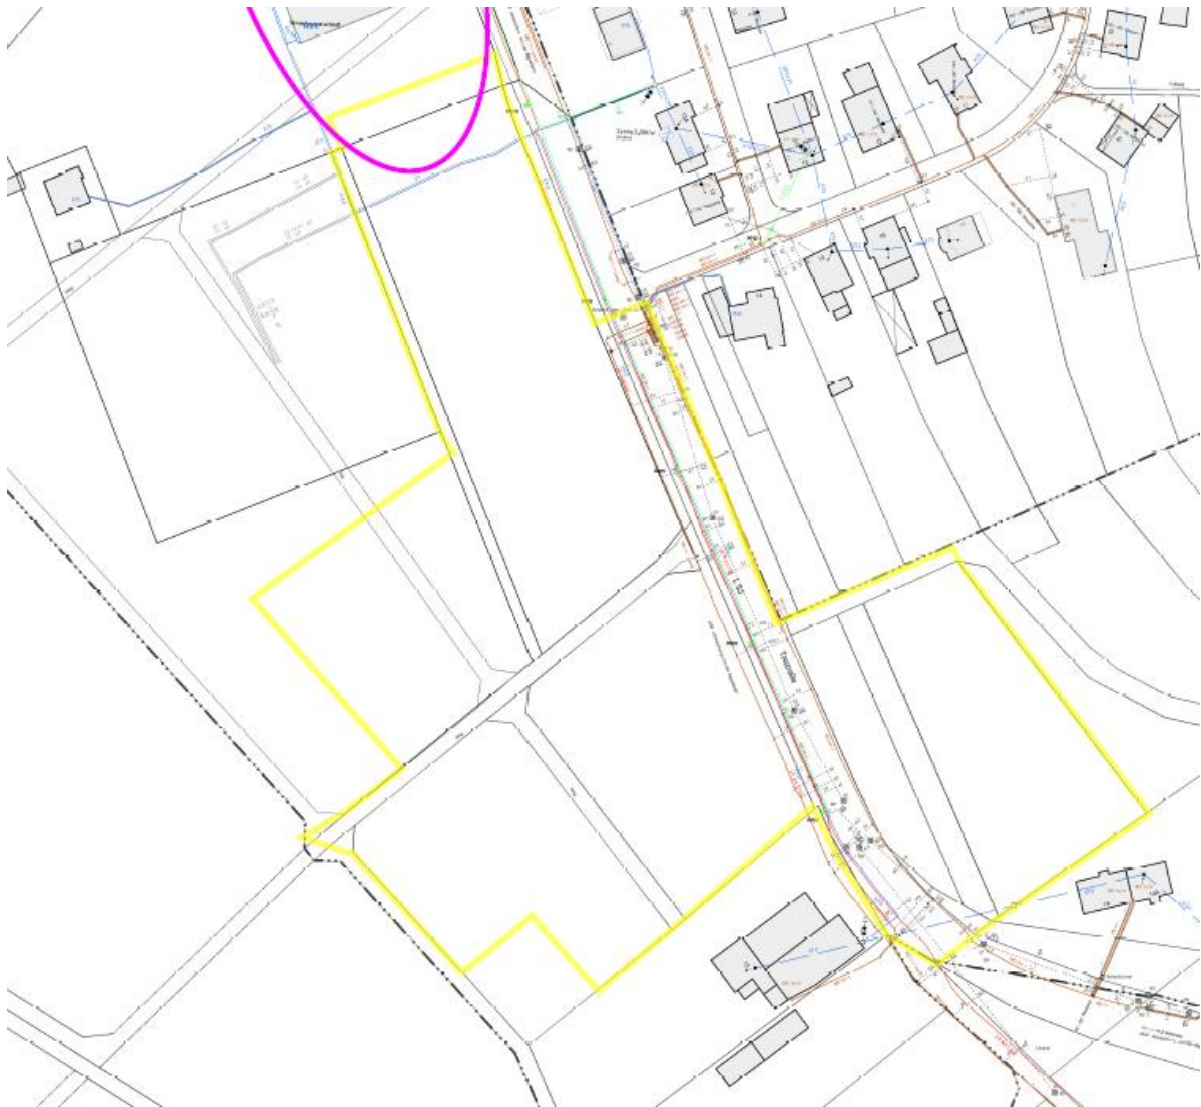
Lageplan mit Verlauf von Bestandsleitungen der Westnetz GmbH
